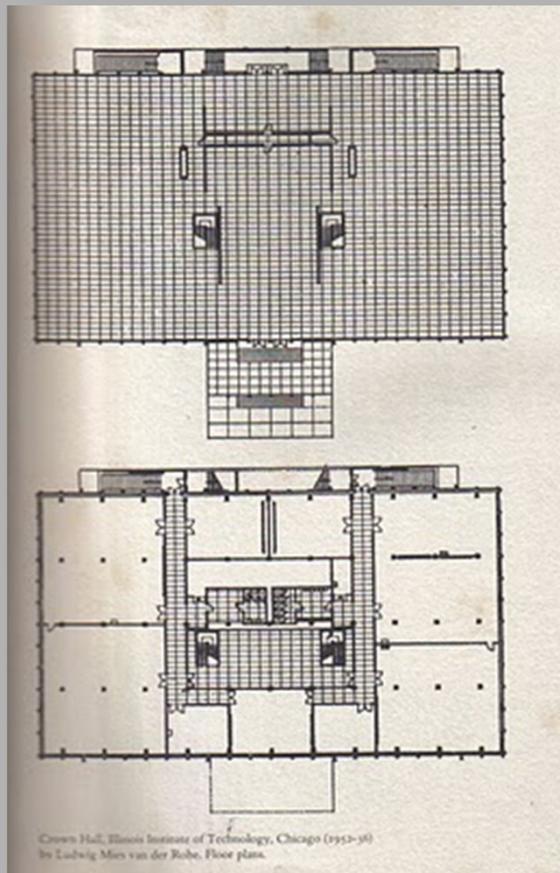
Planta Baixa – Crown Hall, Chicago, 1955. Mies van der Rohe.
